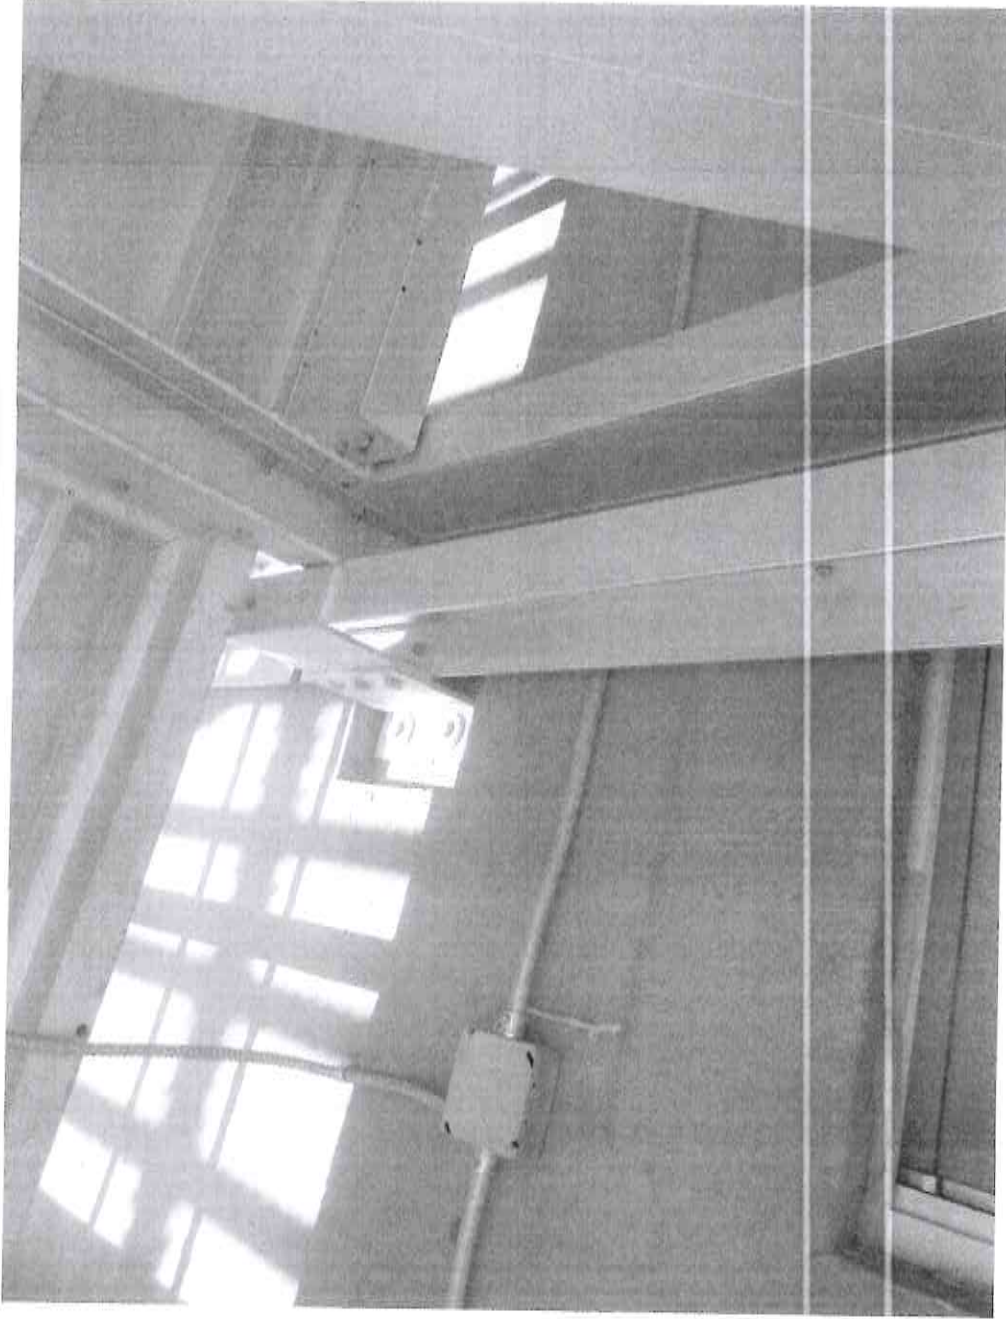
Nivel 10, fisuras en capa de compresión de losa Nervada.
